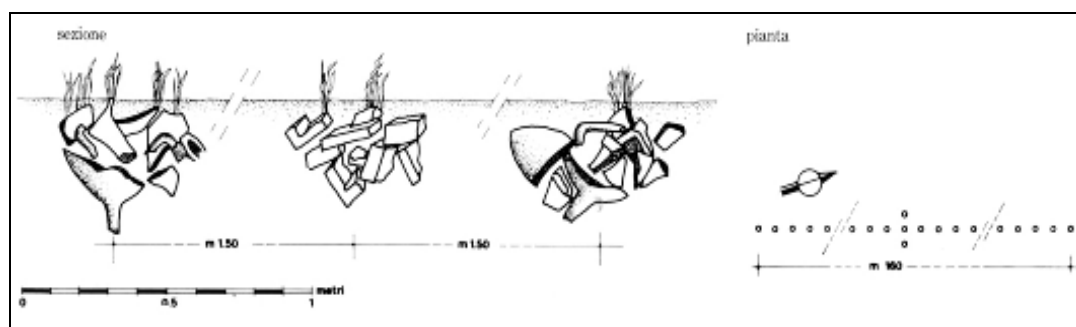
Planimetria (in basso e a destra) e prospetto della struttura LV46, canale Scanello (da DORIGO 1983, modificato).
